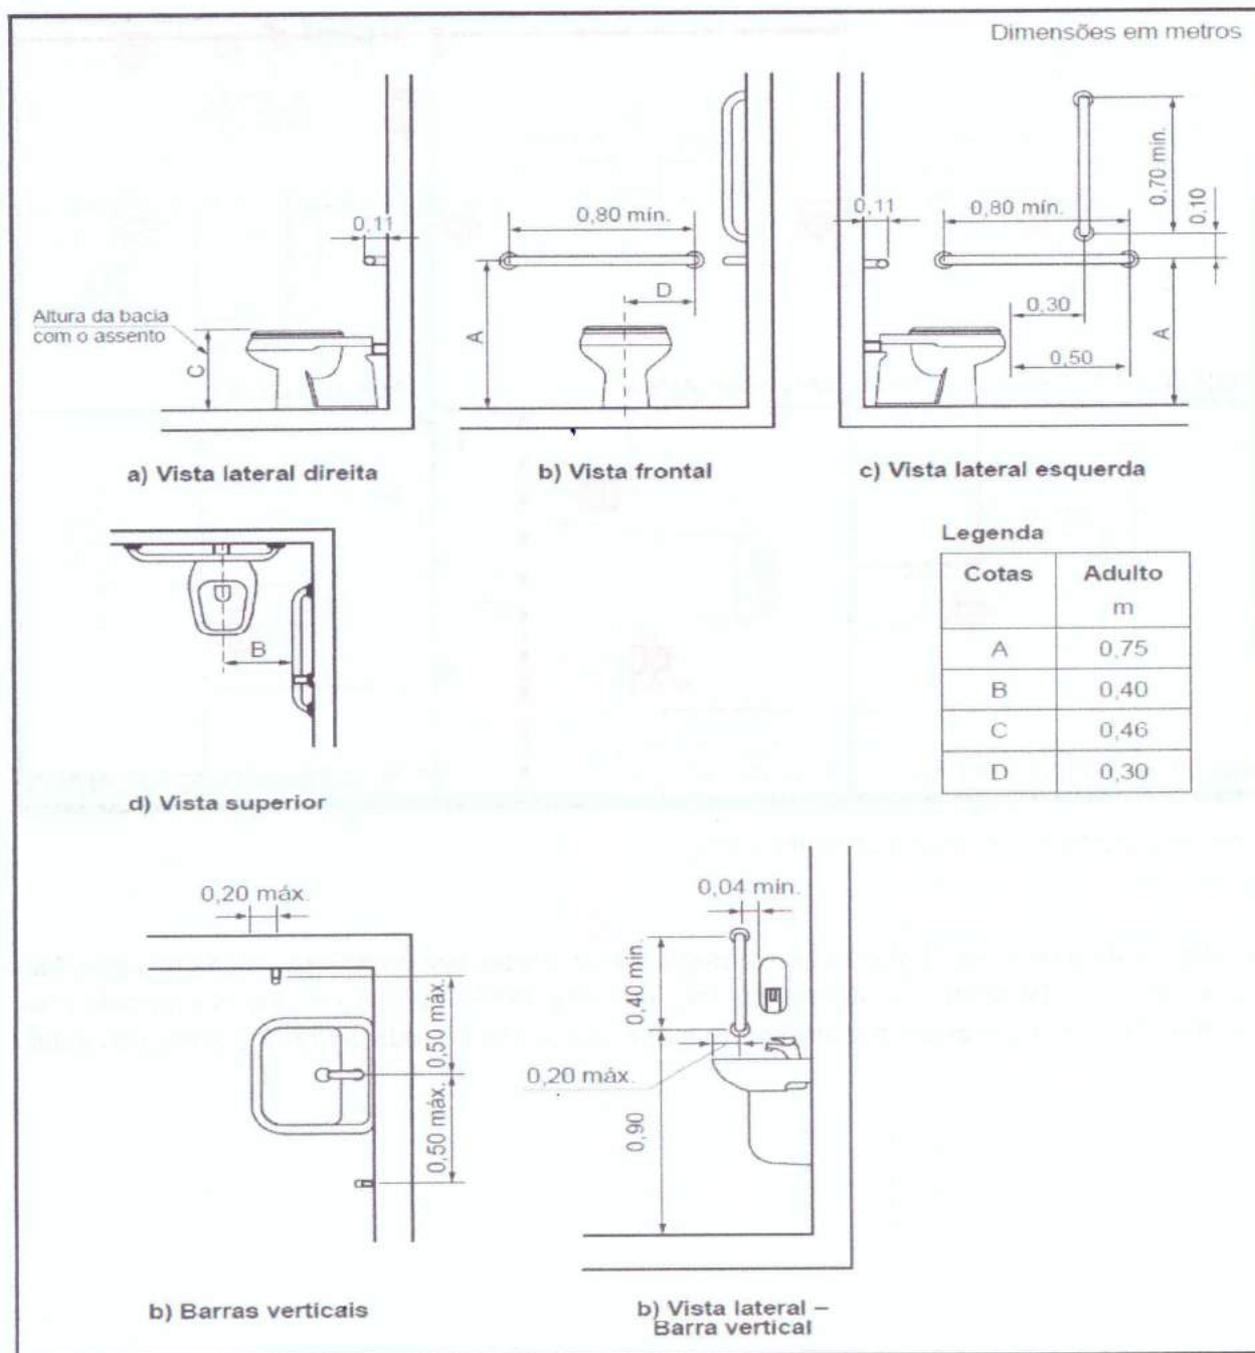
Banheiro para PNE no pavimento térreo da Sala 03
